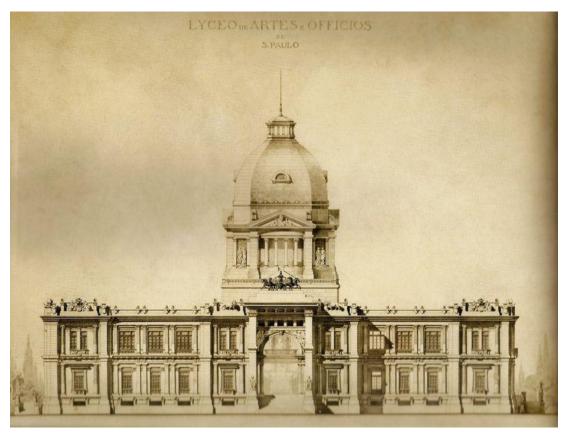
Elevación frontal de la Pinacoteca, plano de fachada 1897
